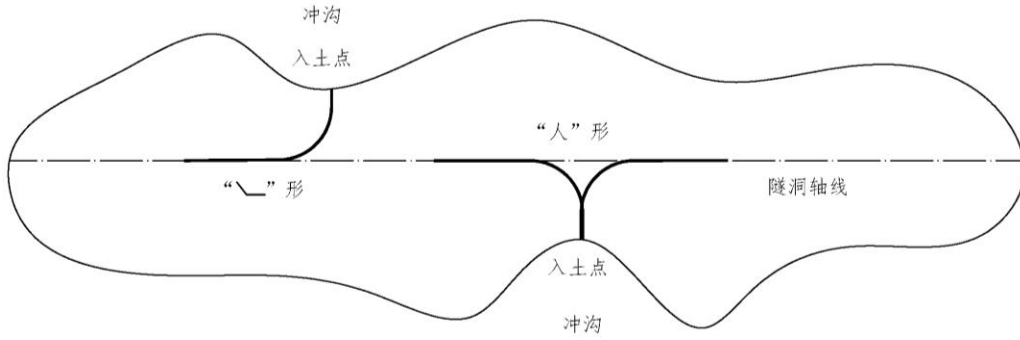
深埋长隧洞水平定向钻孔轨迹平面示意图
